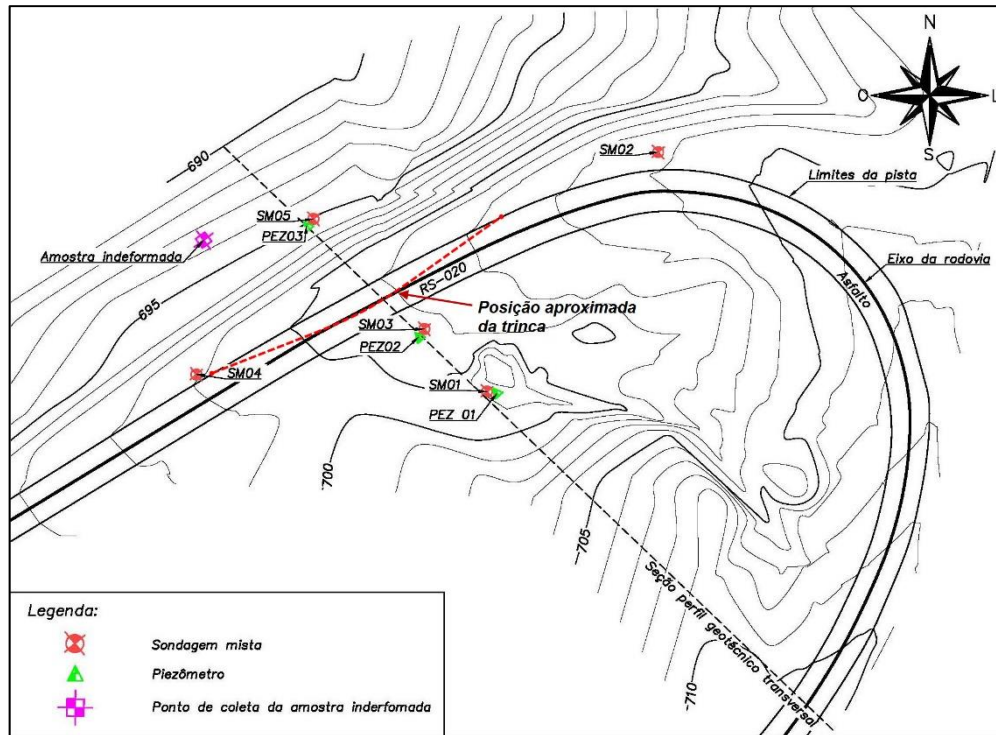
Localização dos ensaios sobre a planta baixa topográfica
